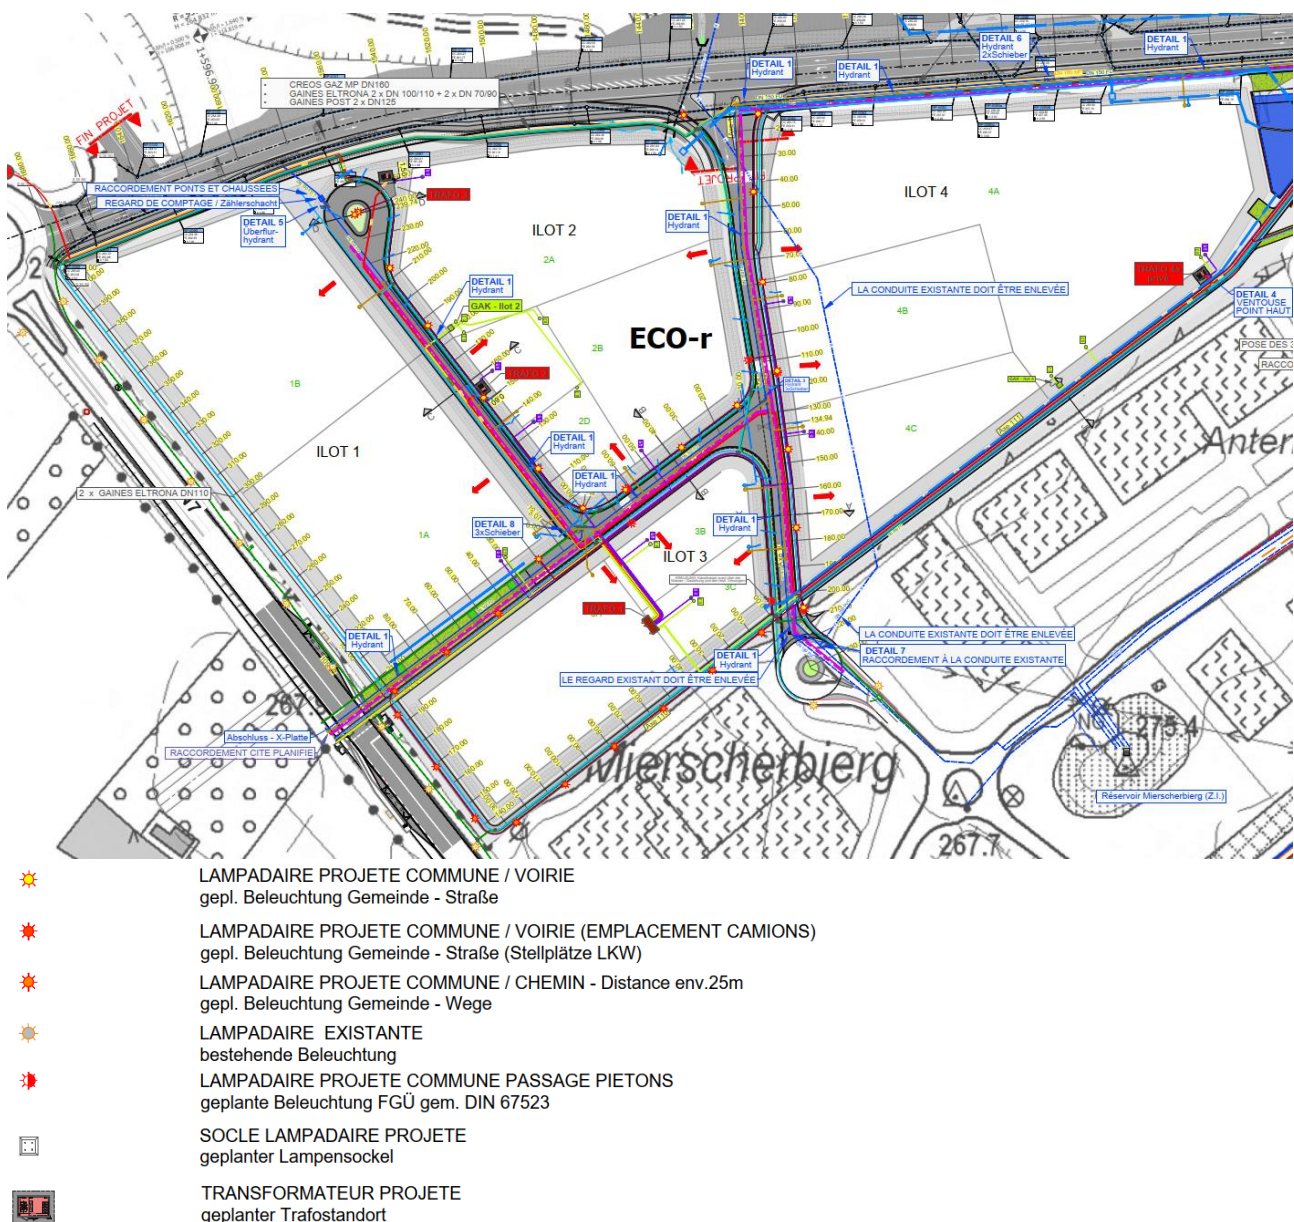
Geplante öffentliche Beleuchtung – Planzone West (Quelle : BEST S.A. 2025). Vollständige Darstellung in Anhang 04.
